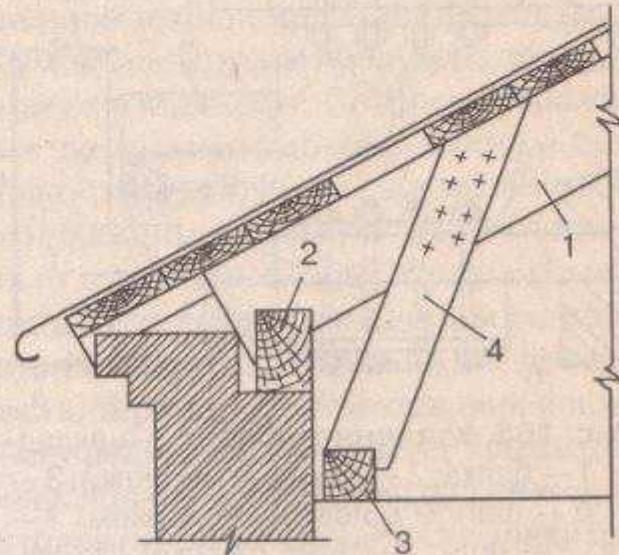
Укрепление стропильной ноги: 1 — стропильная нога; 2 — маузерлат; 3 — брус; 4 — подкос
